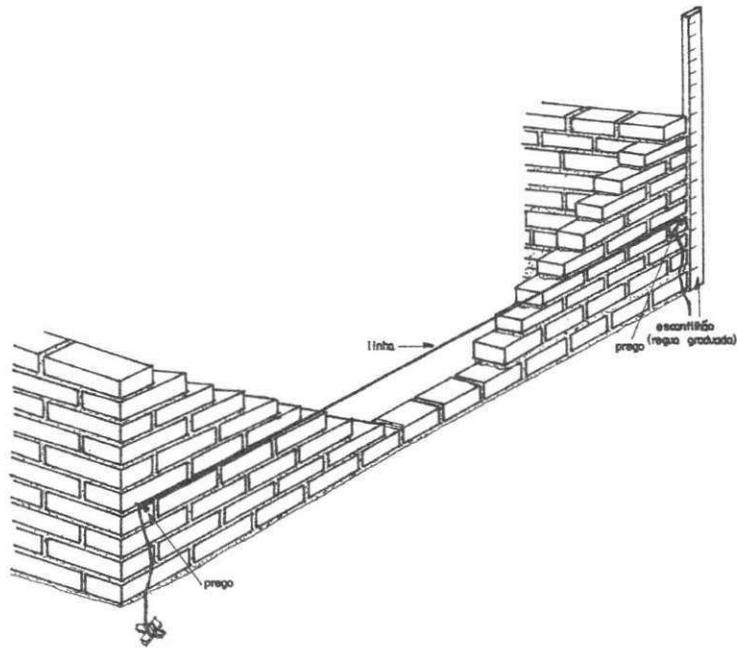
Detalhe do nivelamento da elevação da alvenaria
